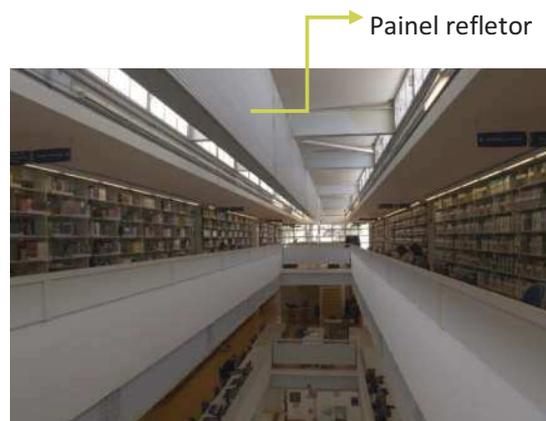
Terceiro Pavimento – detalhe painel refletor. Fonte: Adaptado de Archdaily, 2014
